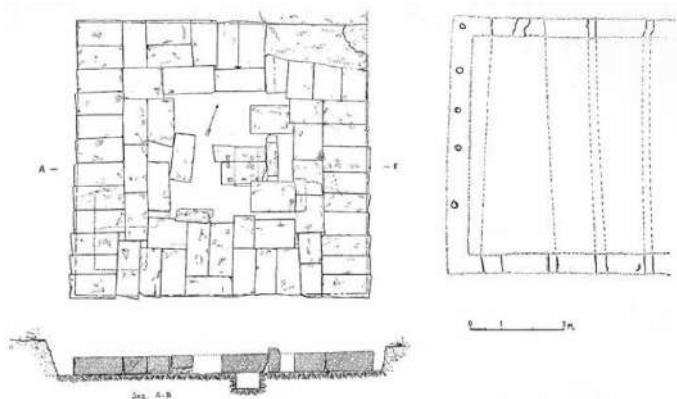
Pianta dettagliata e sezione del mausoleo ellenistico e della fossa funeraria, da Gentili 1967-1968.
